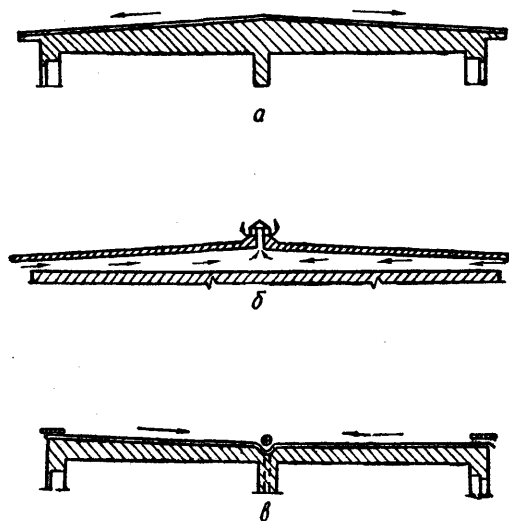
Схемы бесчердачных (совмещенных) крыш:
